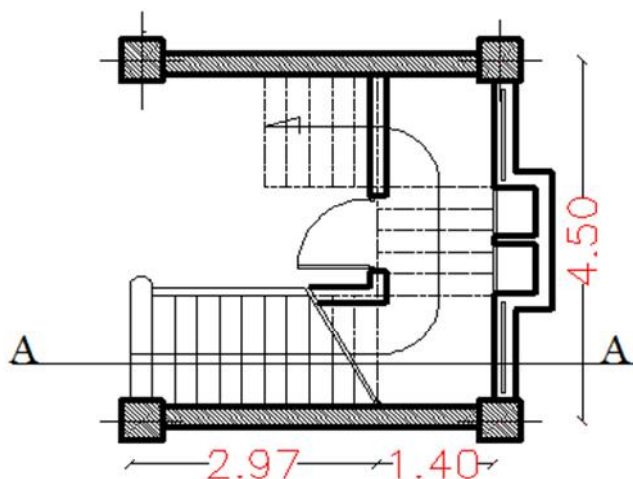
Vue en plan de la cage d'escaliers à étudier
